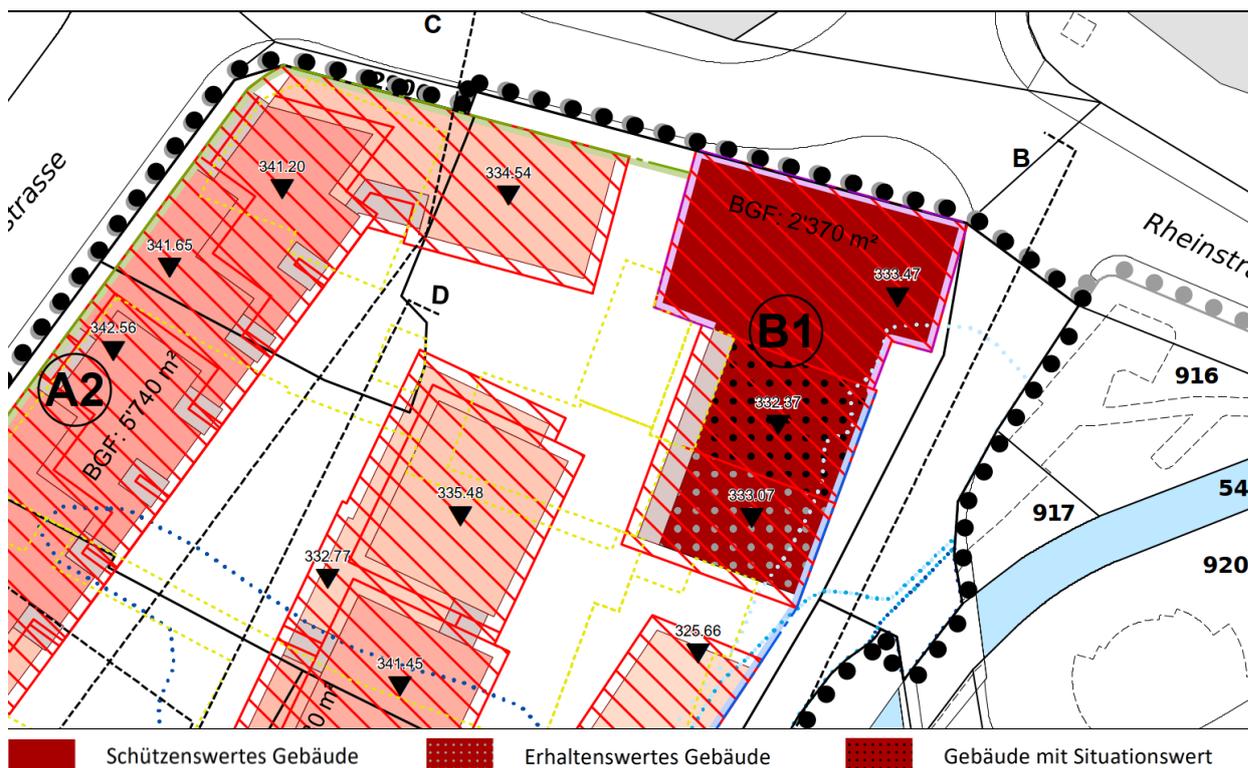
Ausschnitt Quartierplan Lüdin: Baubereich B1 mit Lüdin-Haus (nördlich) und Schützenstrasse 4 (südlich) (Jermann AG 2022)
